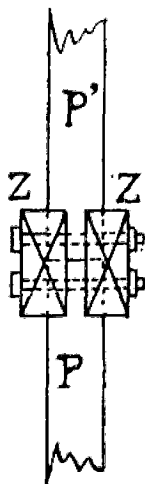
Disposition d'assemblage des poteaux d'une palée.
